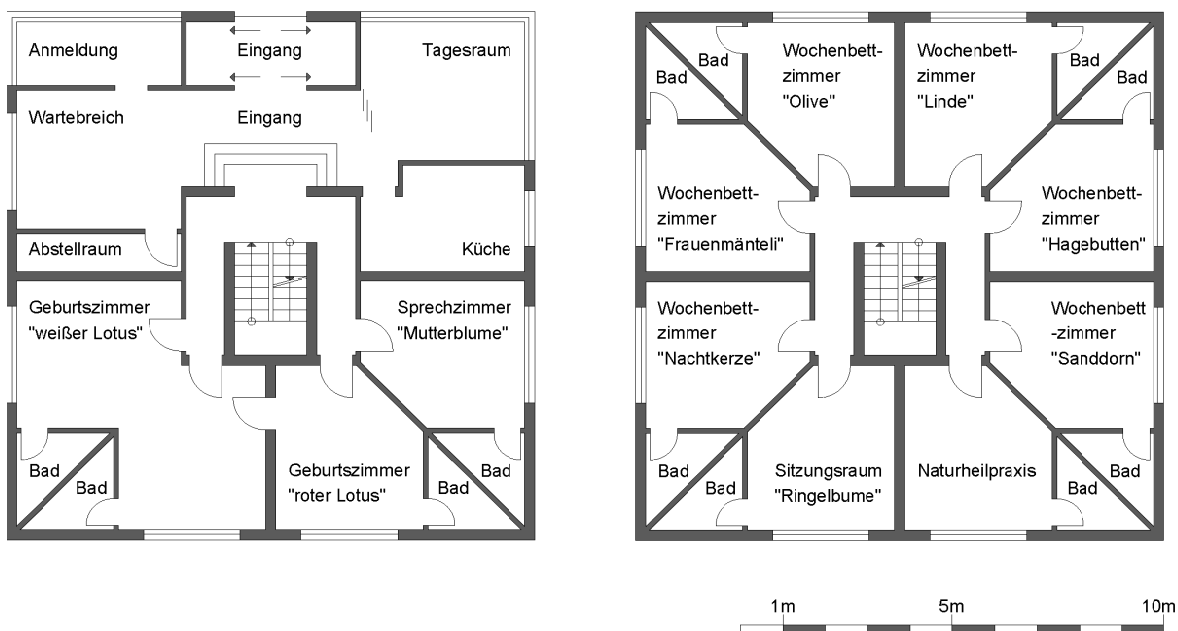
Grundriss Erdgeschoss und Obergeschoss des Entbindungsheims "Geburtshaus Zürcher Oberland"
